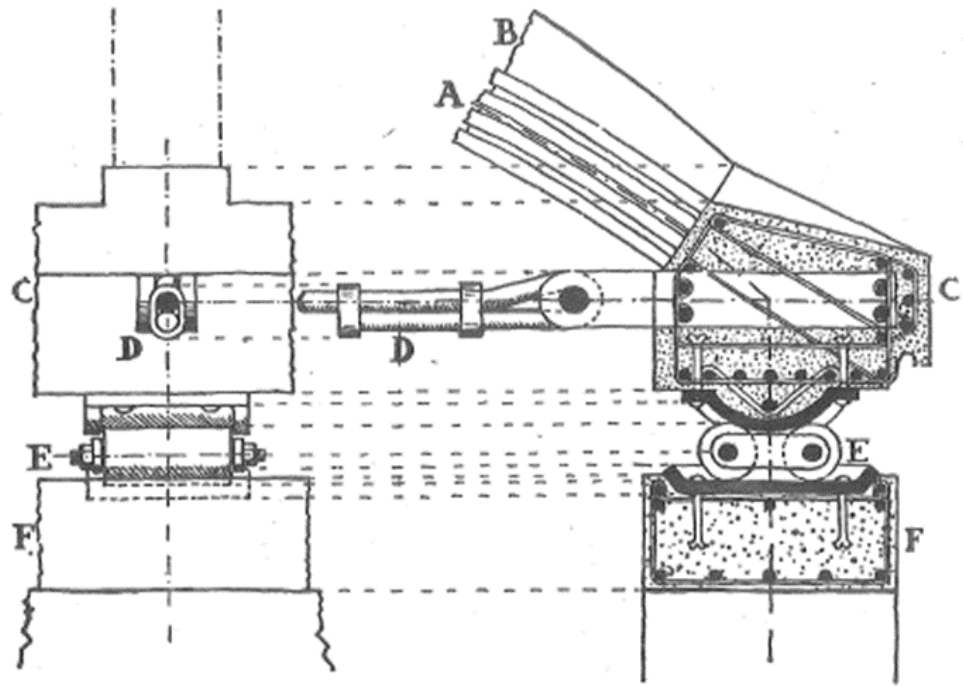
Apoyo de giro y deslizamiento (detalle de la fig. 46):
